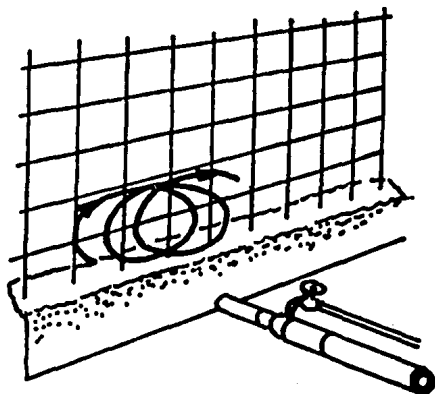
Movimiento recomendado para la colocación del concreto lanzado.
